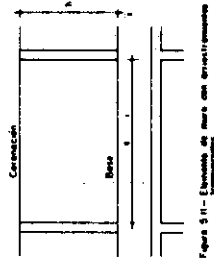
Elemento de muro con arriostamiento horizontal
